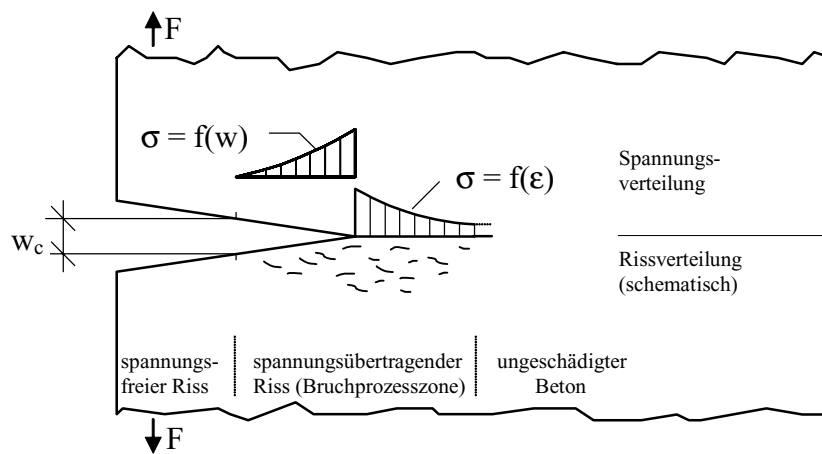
Spannungsübertragung über einen Riss hinweg in einem senkrecht zum Riss beanspruchten Betonkörper nach dem Konzept der Kohäsionsrissmodelle
